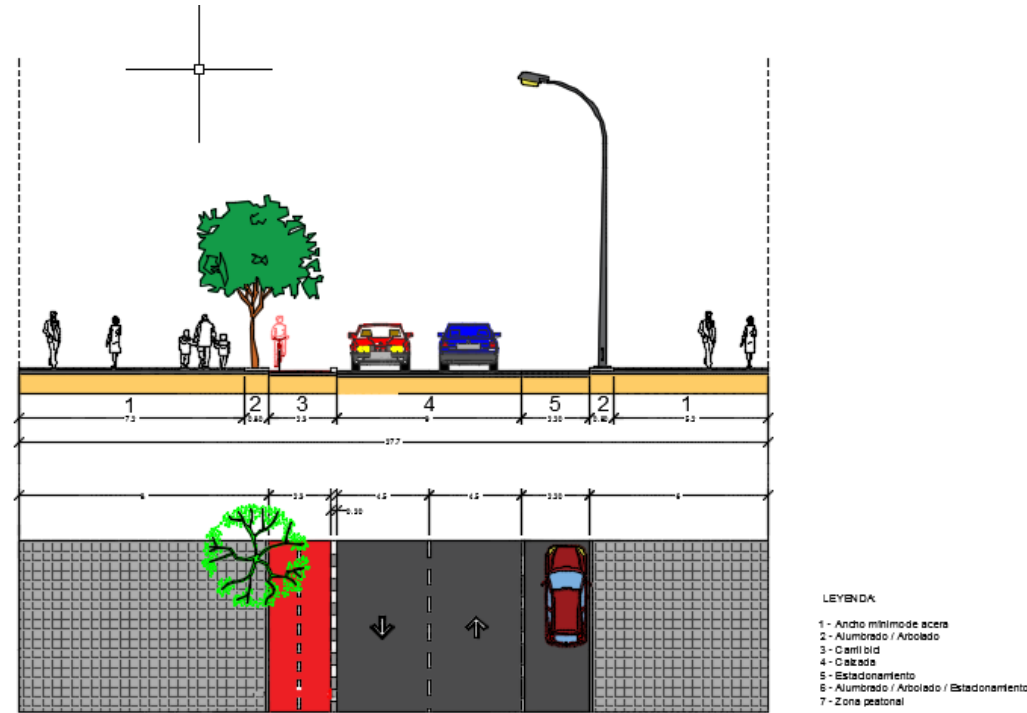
Avenida del Mediterráneo. Sección tras la actuación.
